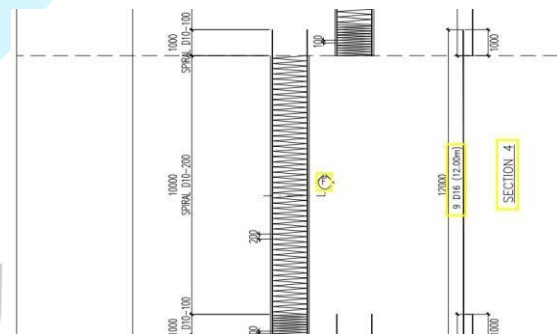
38 Shop drawing detail tulangan bored pile type G section 3
